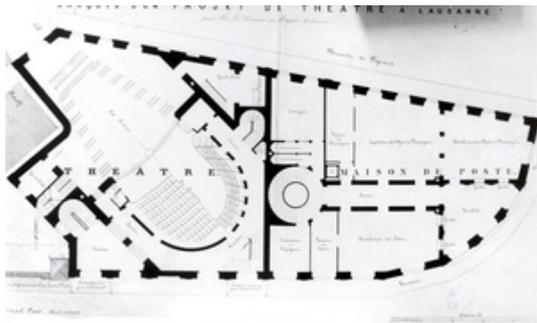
Lausanne, Postgebäude, Grundriss Vorprojekt, 1862
